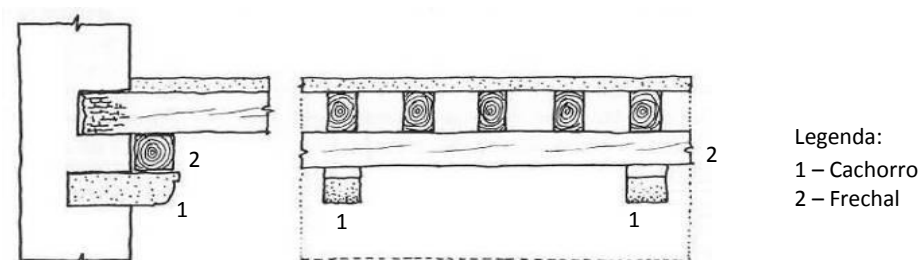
Cachorros em Pedra e Frechal – Corte e Alçado
